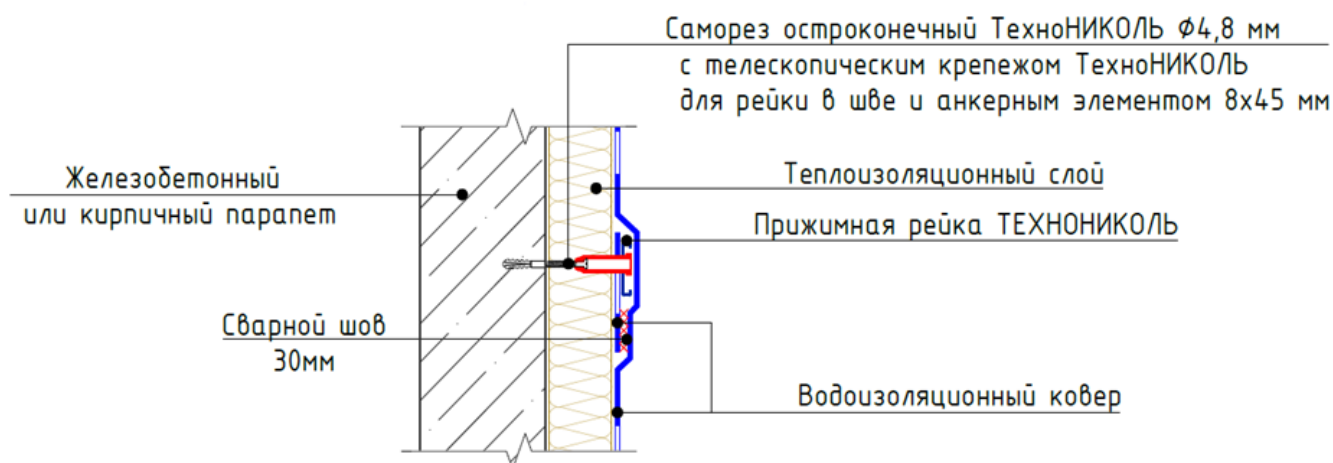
Промежуточное крепление теплоизоляции и водоизоляционного ковра из ПВХ-мембраны на высоком железобетонном или кирпичном парапете
